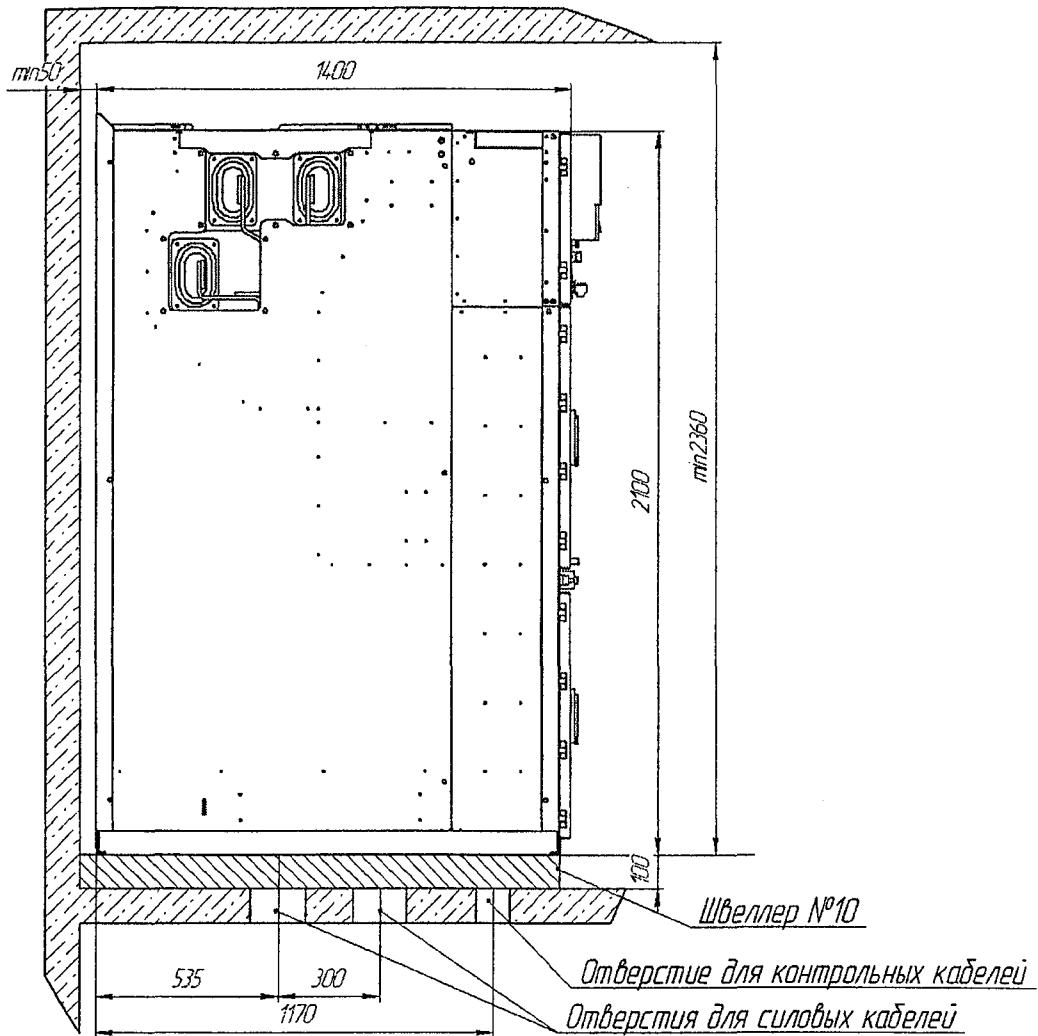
Установка шкафа КРУ «Темза» на фундаментной раме
